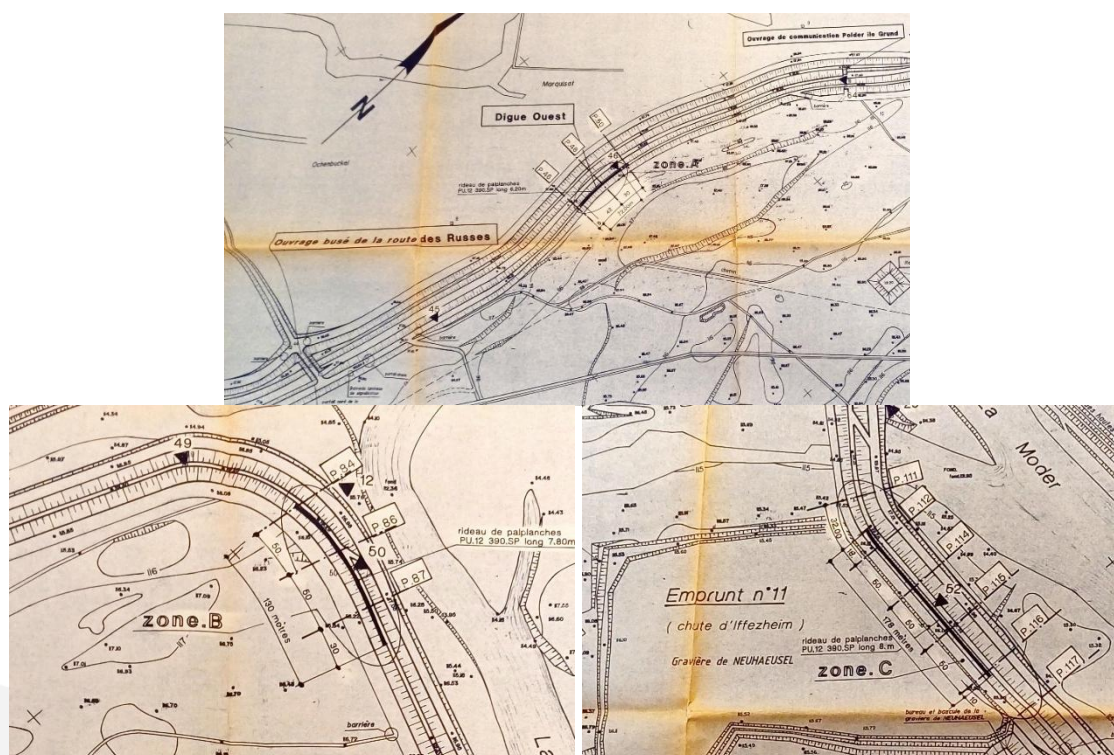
Localisation des rideaux de palplanches – Source : Plan d'implantation de palplanches (Archives VNF)
